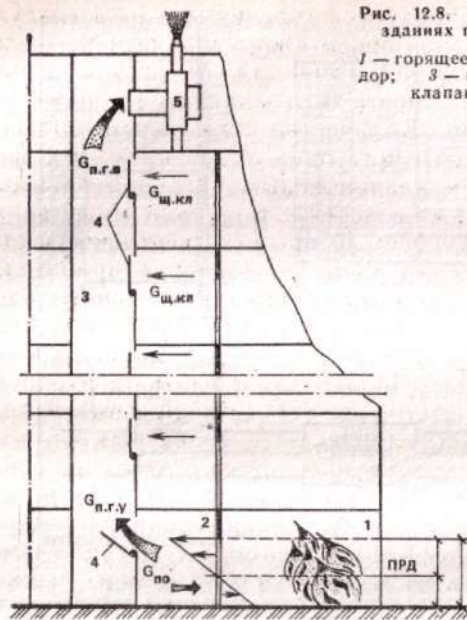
Схема дымоудаления в зданиях повышенной этажности
